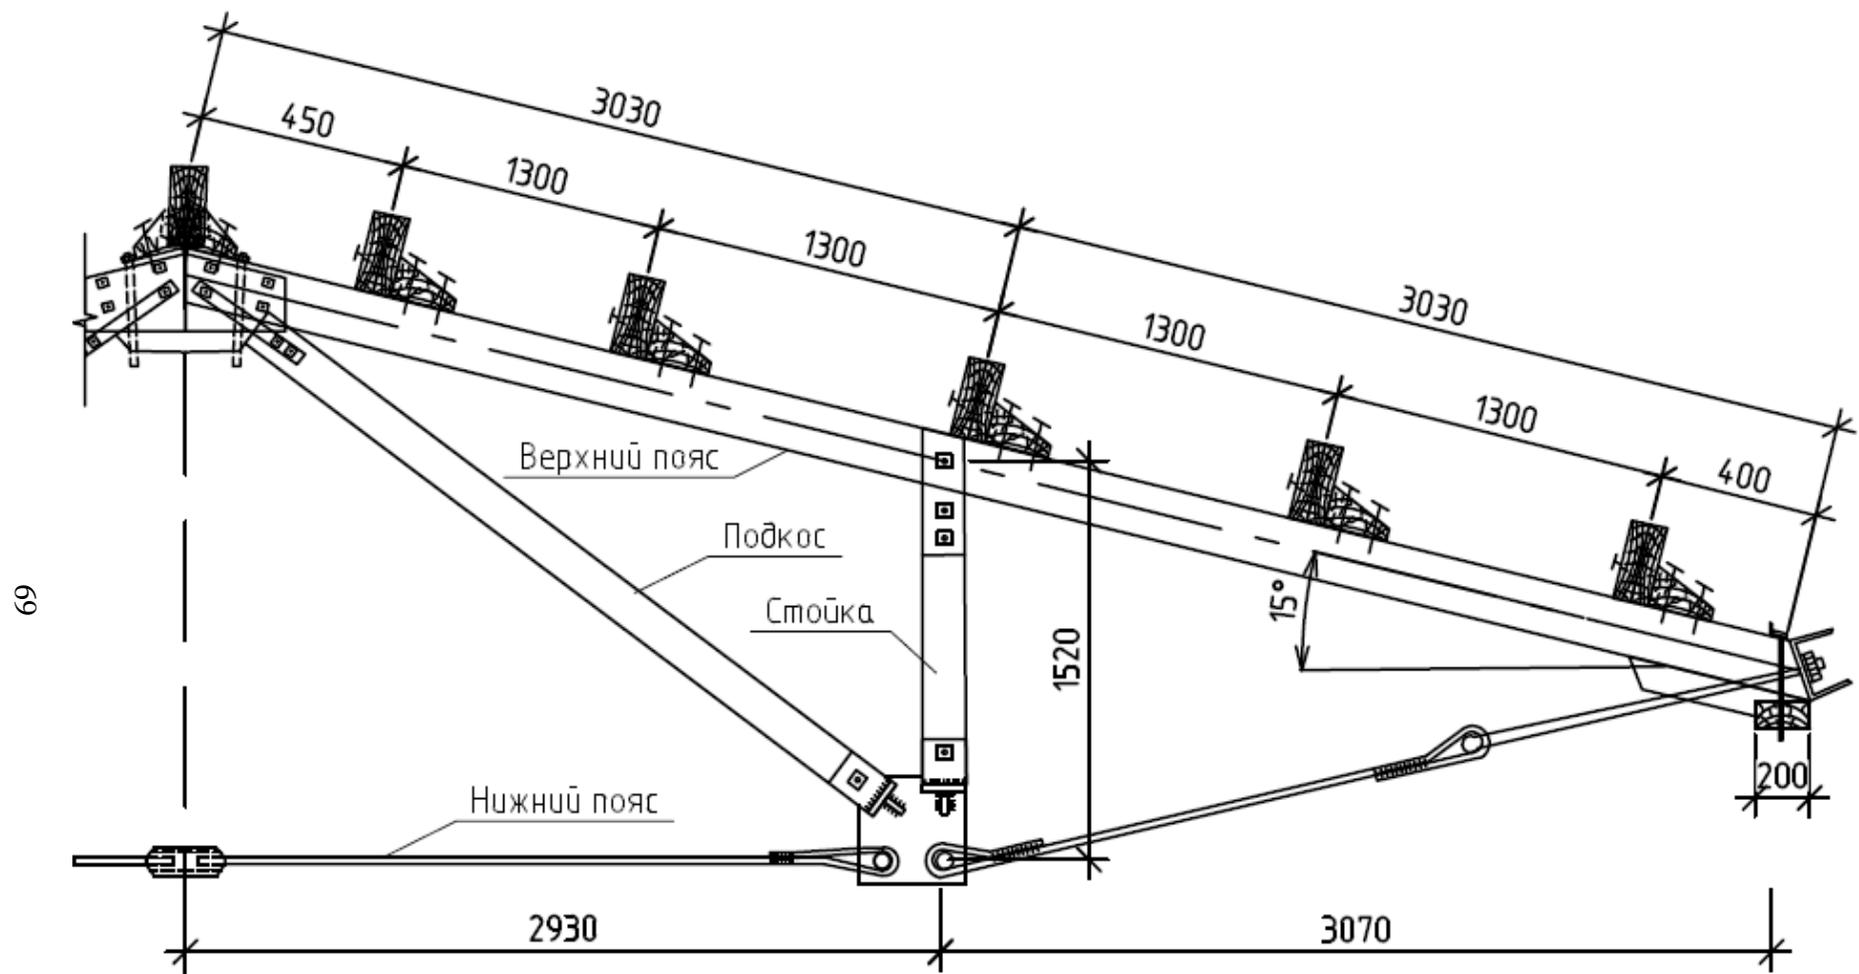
Конструкция двускатной металлодеревянной фермы ФС-1
